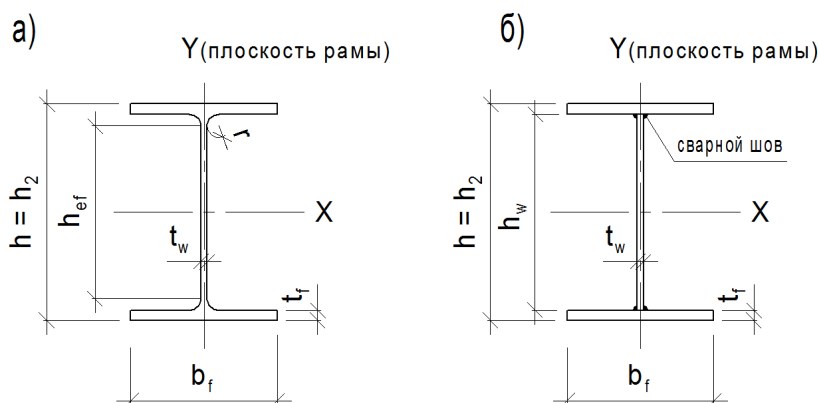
Сечение верхней части колонны: а – прокатное; б – сварное.
